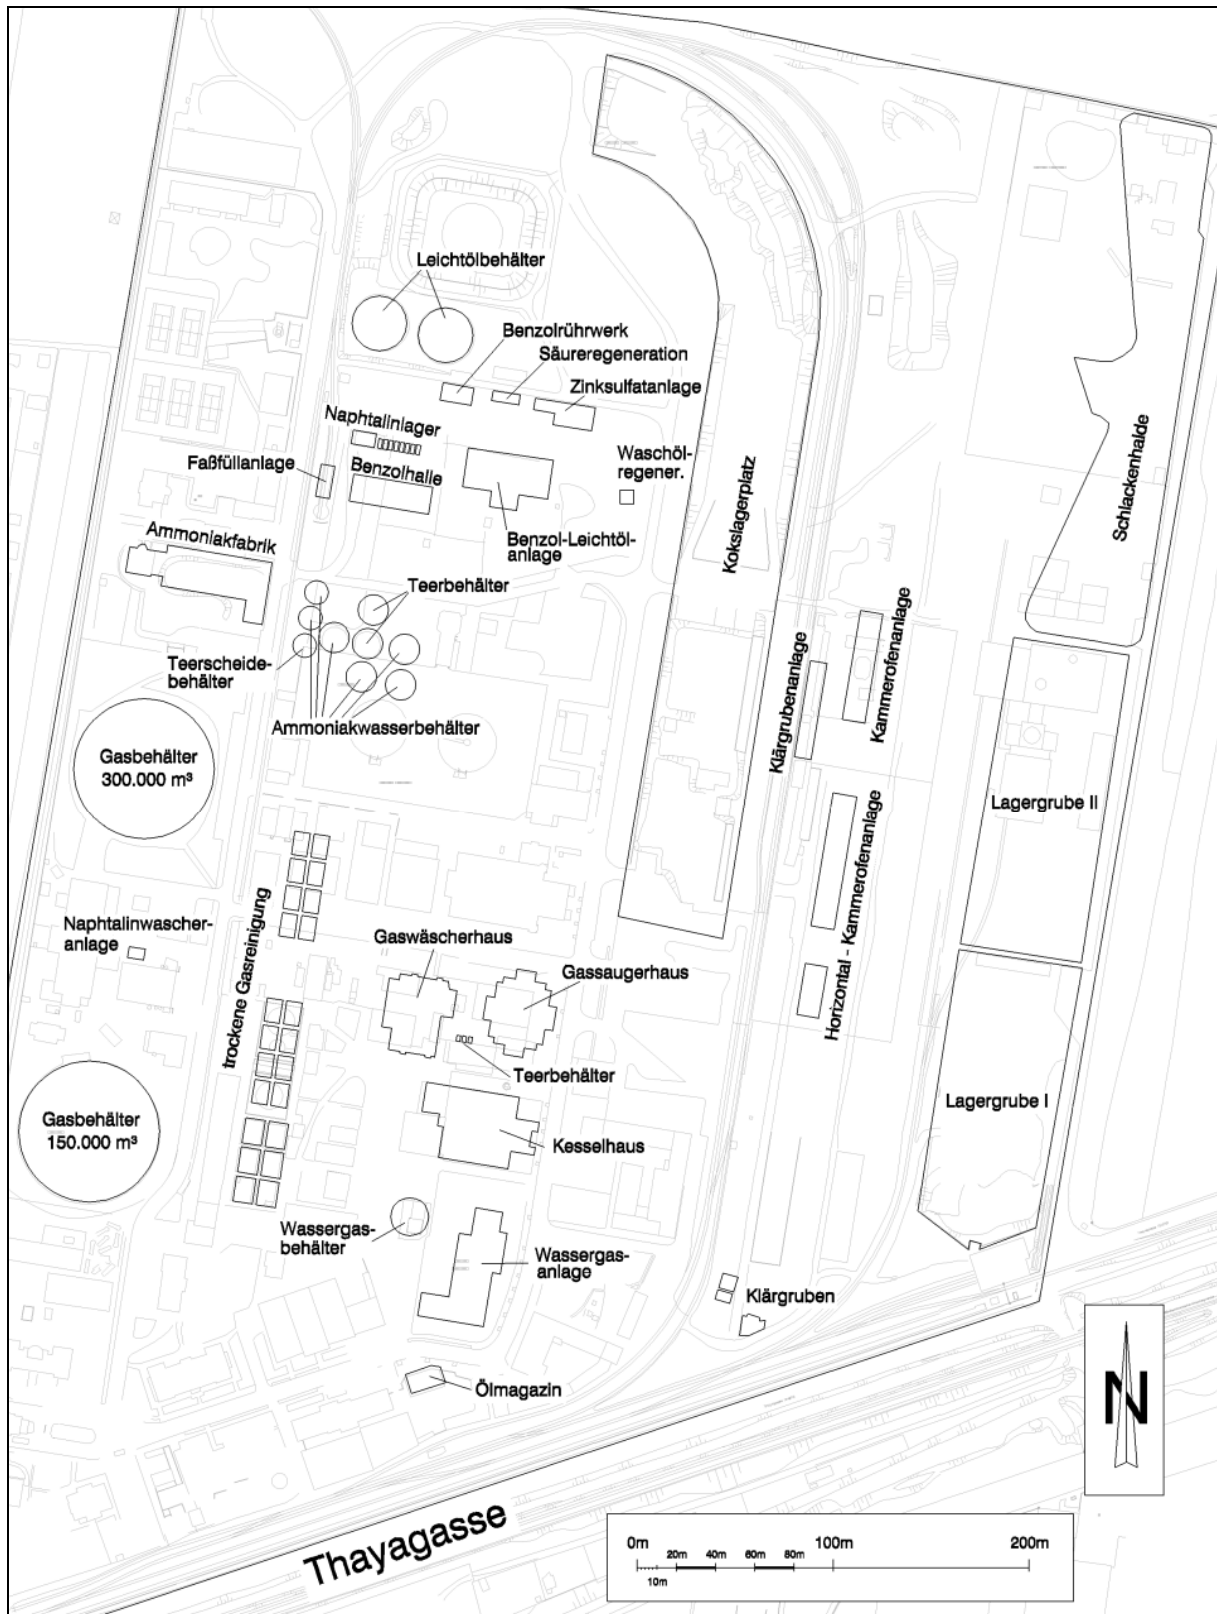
Lageplan mit dem Anlagenbestand aus dem Jahr 1944
